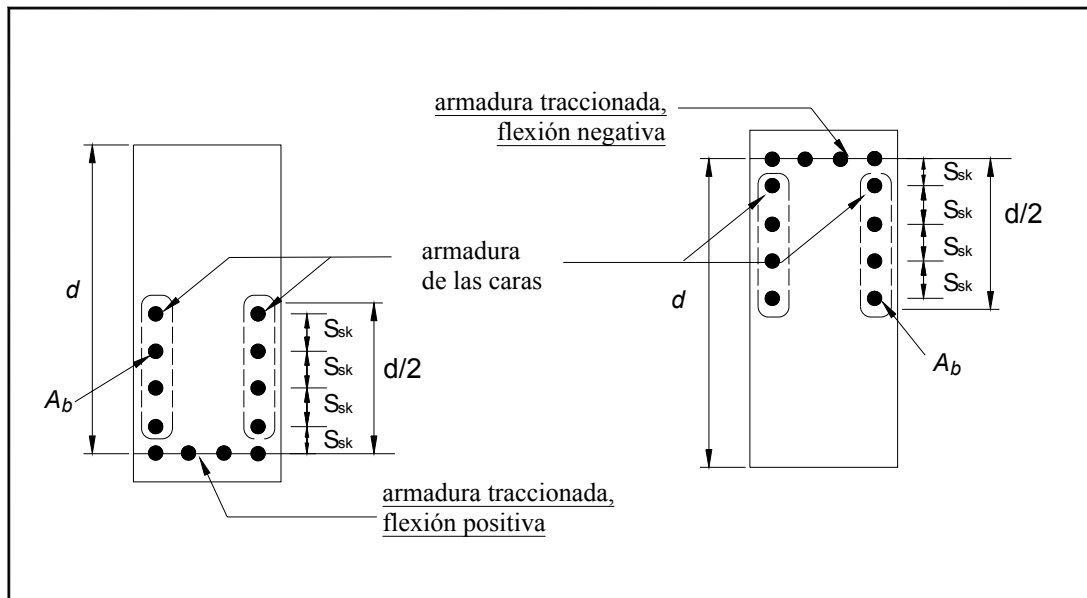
Armadura para las caras de vigas y viguetas con $d > 1 \text{ m}$
